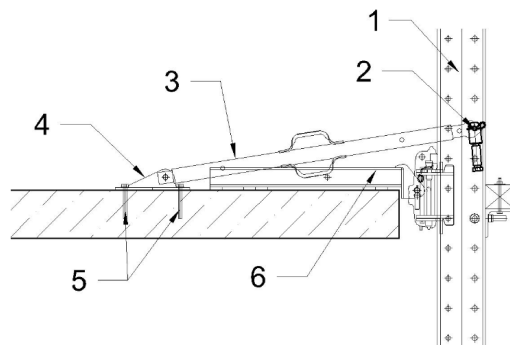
Схема влаштування вітрових зв'язків, де: 1 – захисна панель; 2 – адаптер підкоса; 3 – розпірка; 4 – п'ята RCS; 5 – болт анкерний; 6 – башмак перекриття
